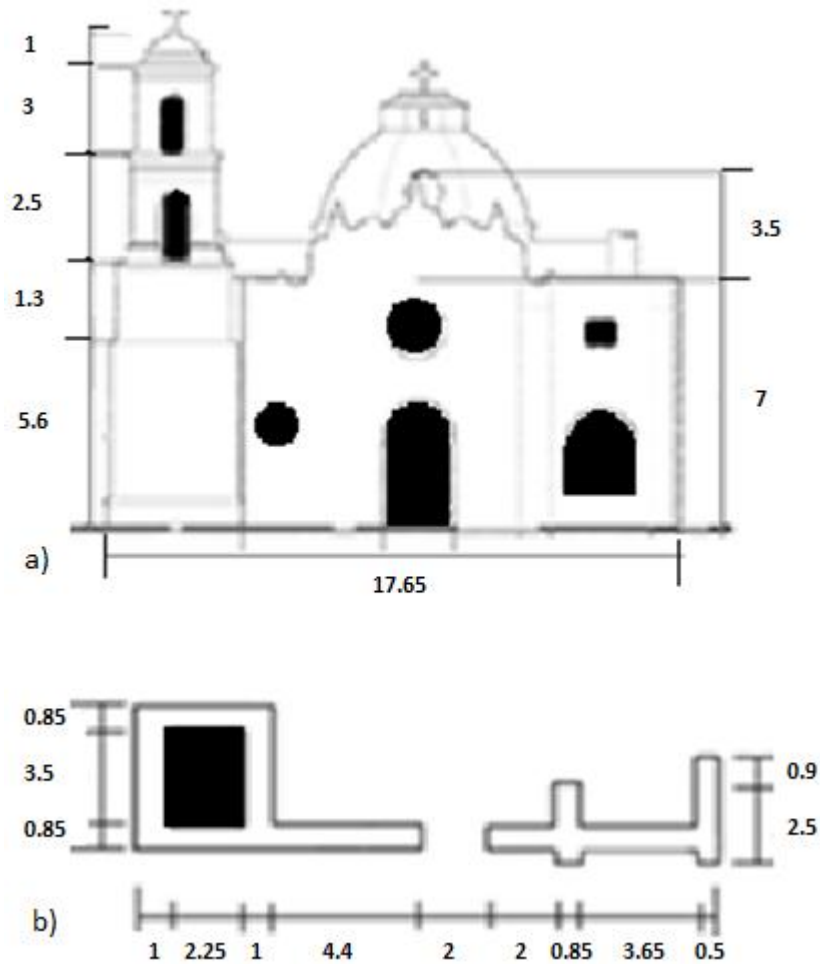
Geometría de la fachada de la Parroquia de San Bartolomé Apóstol (dimensiones en m)
